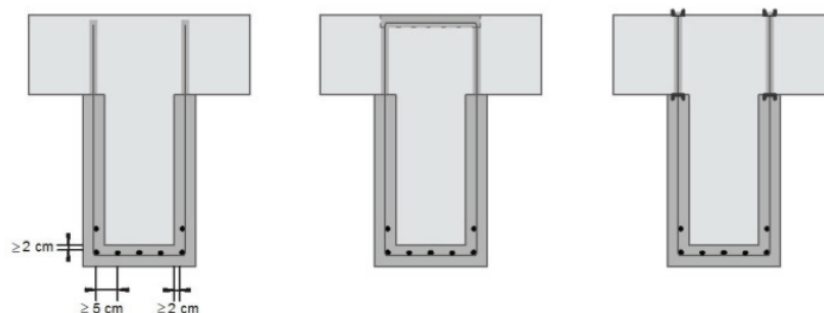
Querschnittsergänzung mit zusätzlicher Betonstahlbewehrung [Seim07]
